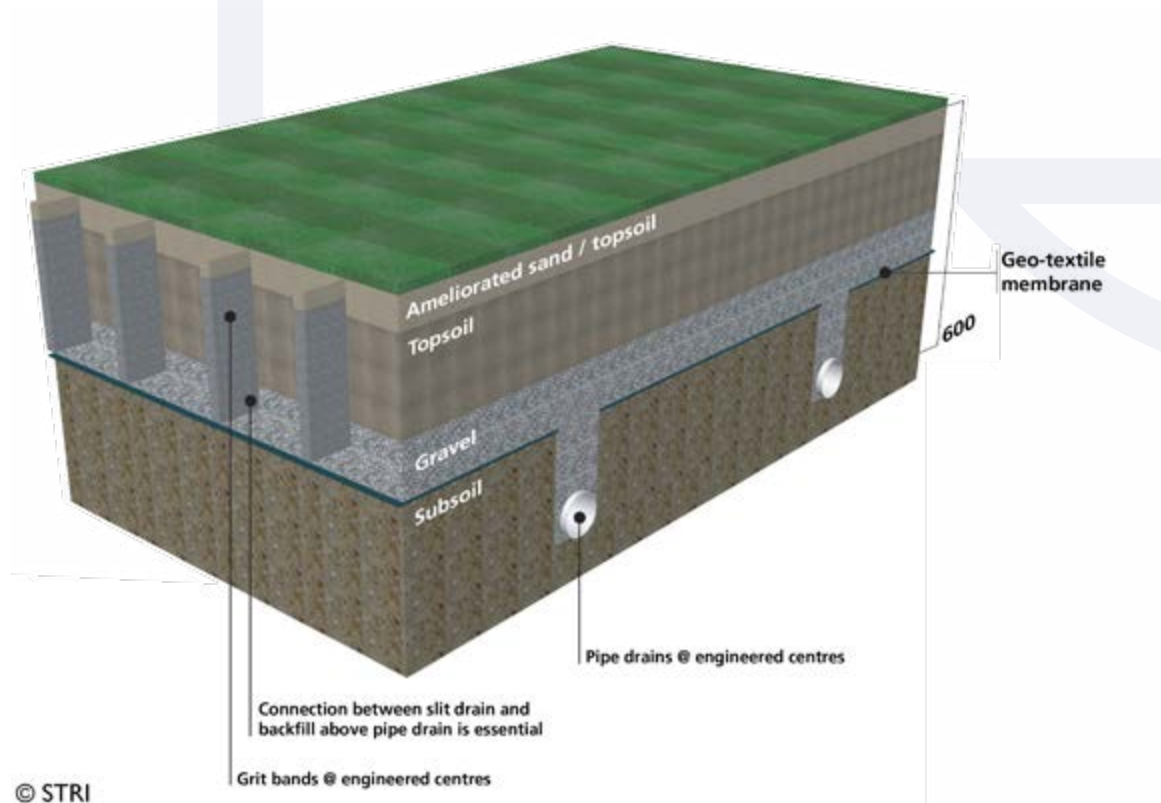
Profil d'un terrain avec zone d'enracinement en terre sur couche de drainage en gravier
